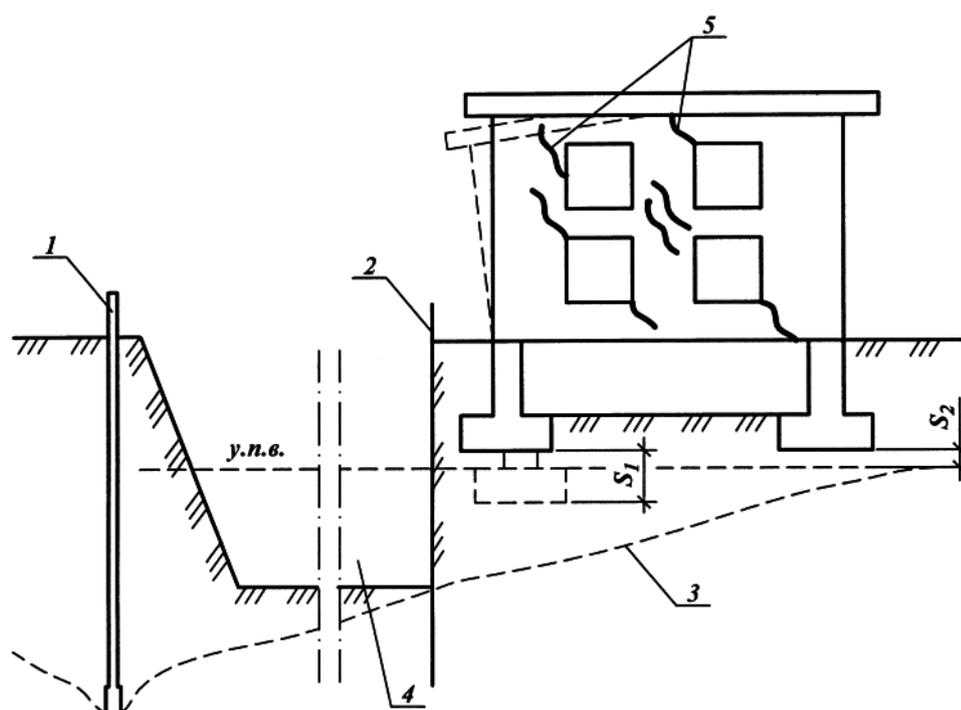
Деформации здания при понижении уровня подземных вод: 1 – иглофильтры; 2 – шпунт; 3 – уровень подземных вод после водопонижения; 4 – котлован; 5 – трещины в здании
